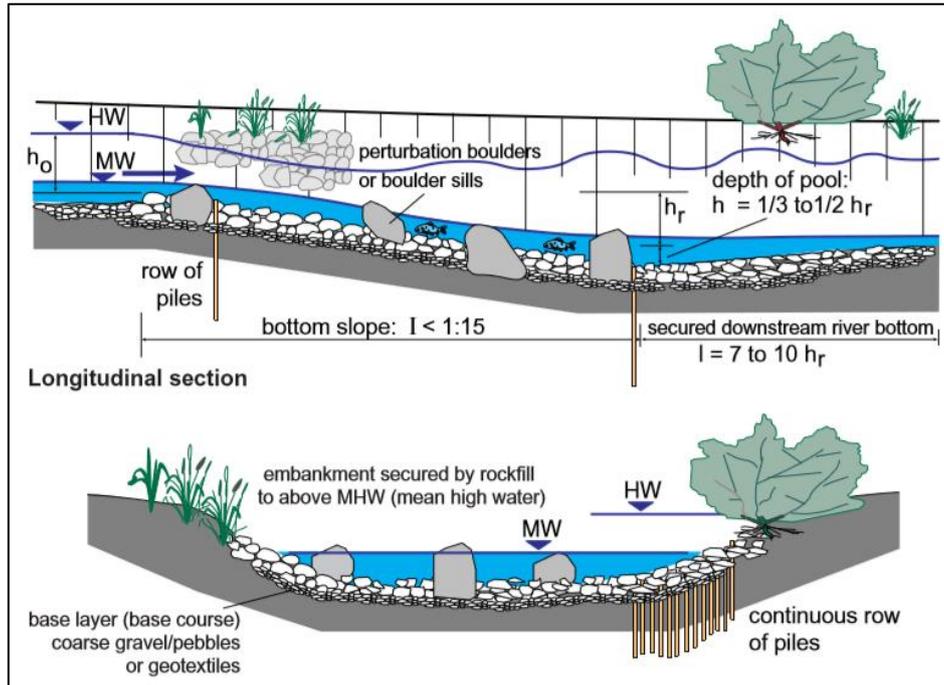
Perfil longitudinal y transversal de una rampa piscícola de piedras.
